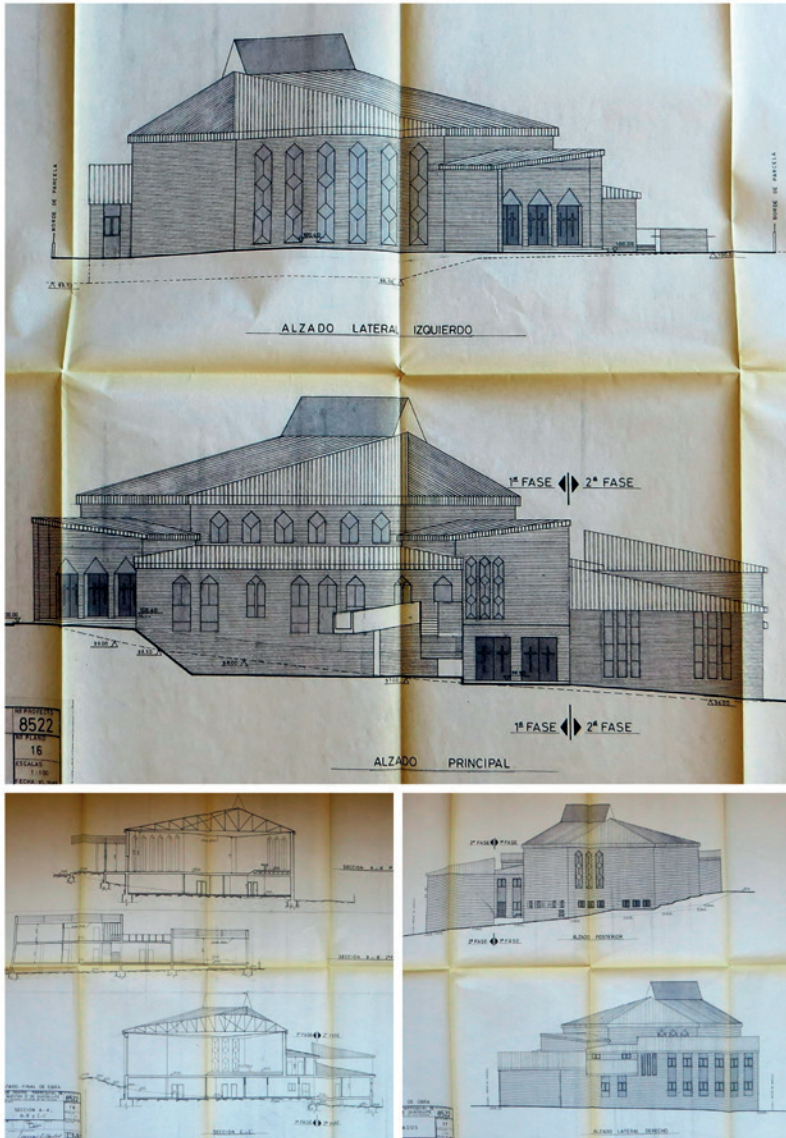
Proyecto de centro parroquial de Nuestra Señora de Guadalupe. Estado final de Obra. Alzado principal. Alzado lateral izquierdo. E: 1:100, 1988. Sección A-A', B-B' y C-C'. E: 1:100, 1988. Alzado posterior y alzado lateral derecho. E: 1:100, 1988.
